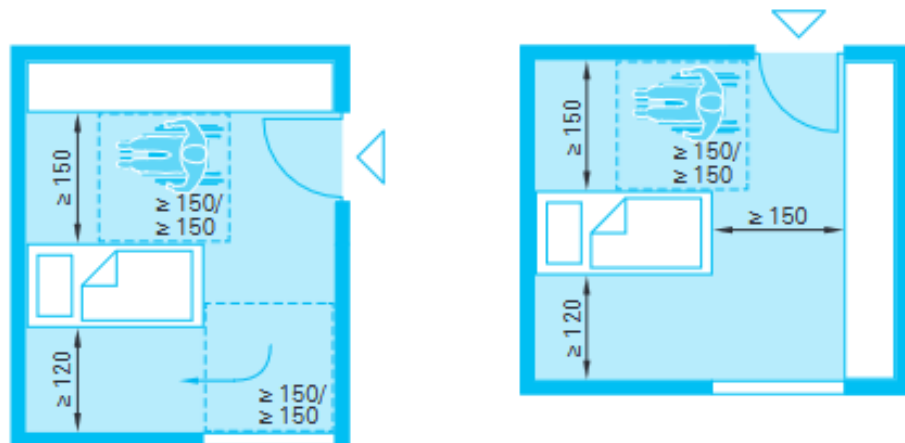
Bayerische Architektenkammer (2014). Barrierefreies Bauen. Planungsgrundlage. Leitfaden für Architekten, Fachingenieure, Bauherren und Interessierte zur DIN 18040, Teil 2 Leitfaden Ausgabe Juli 2013 1. Nachdruck März 2014, S. 94.
